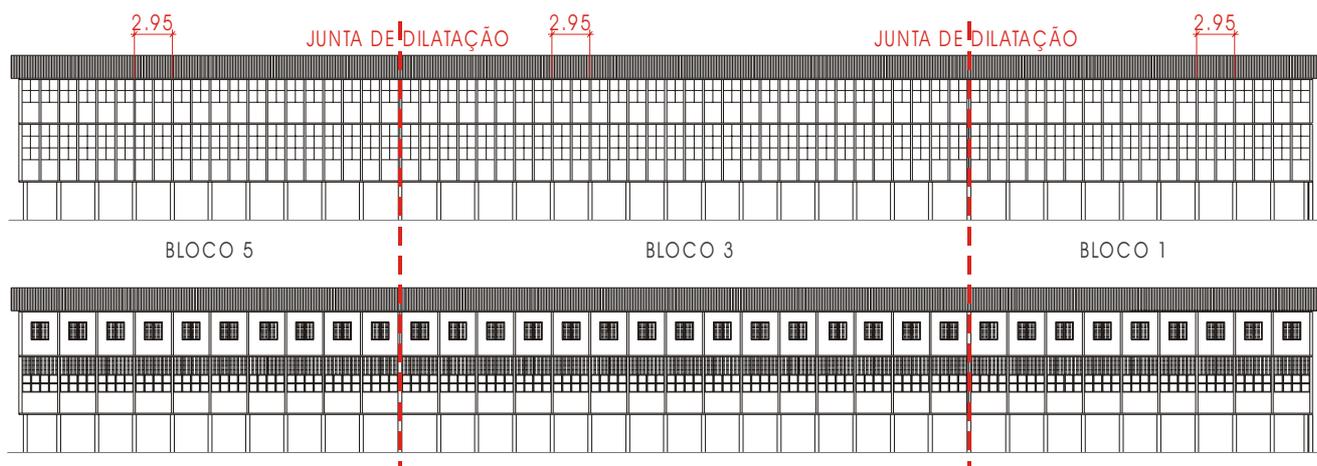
e 111: Fachada Posterior – Primeira e segunda versões, respectivamente. Sem escala. (Desenho da autora).
